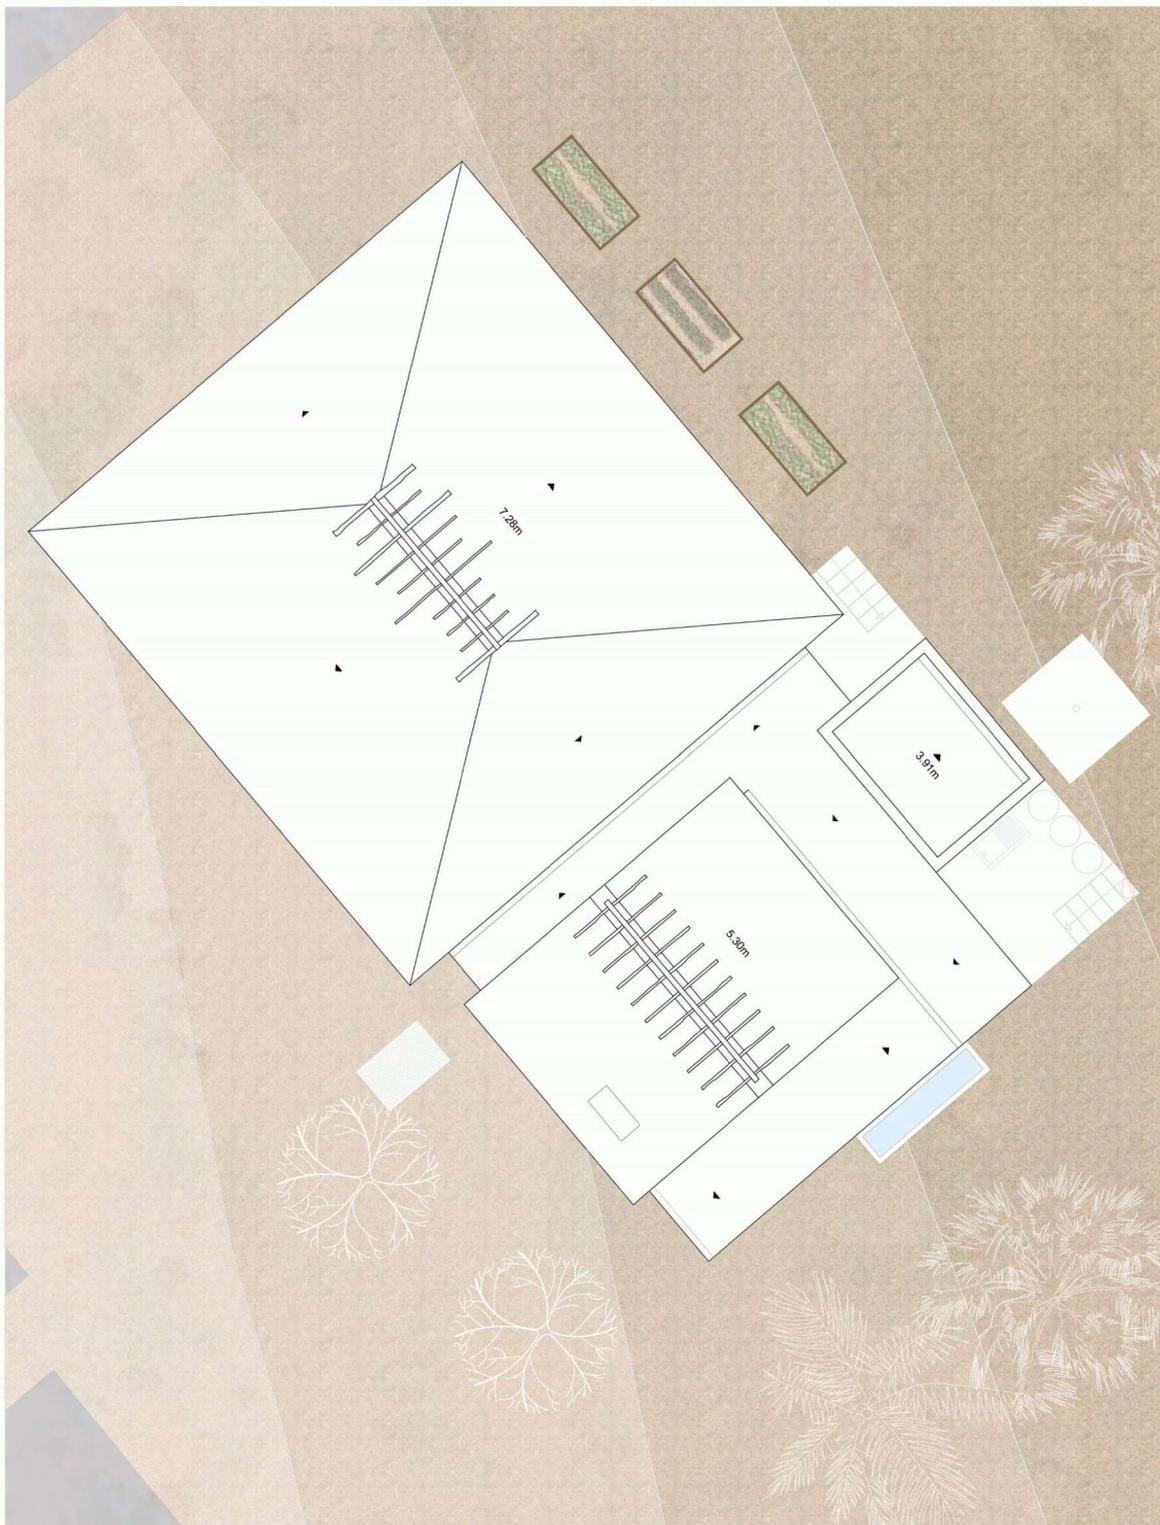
10. Proposta: Planta da cobertura, escala 1.100
